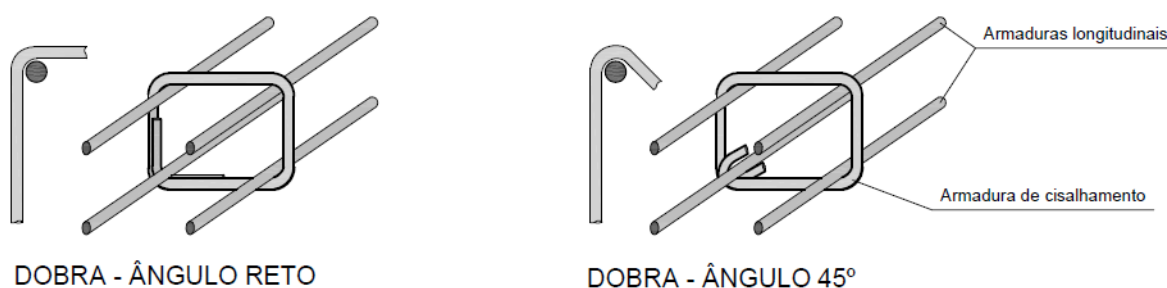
Detalhamento da ancoragem da armadura tipo estribo
